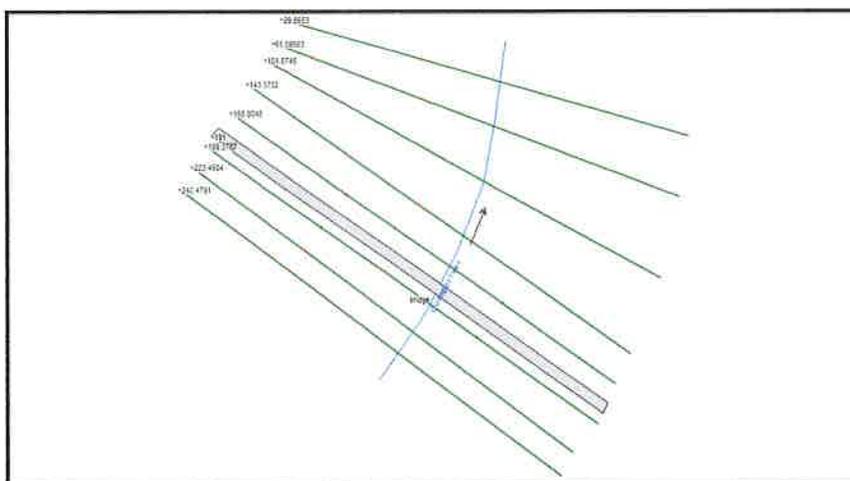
Vista de Planta del Modelo Hidráulico en Hec-Ras.
